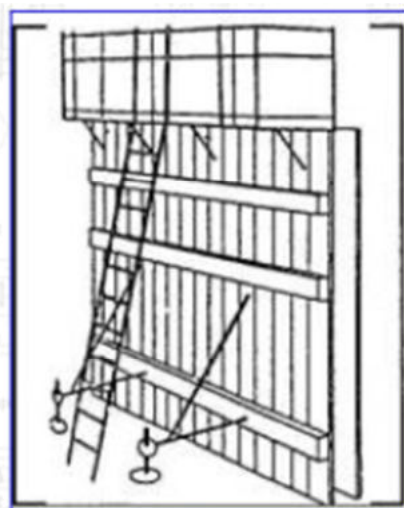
допустимые отклонения при монтаже опалубки стен
